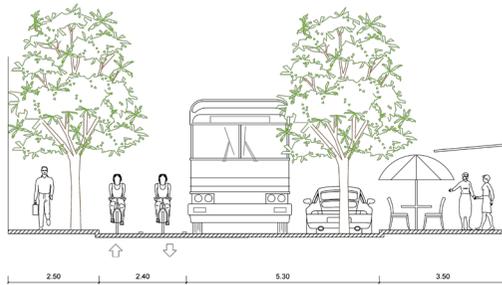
Tipologías de calles: Vía conectora. Planta y corte.
